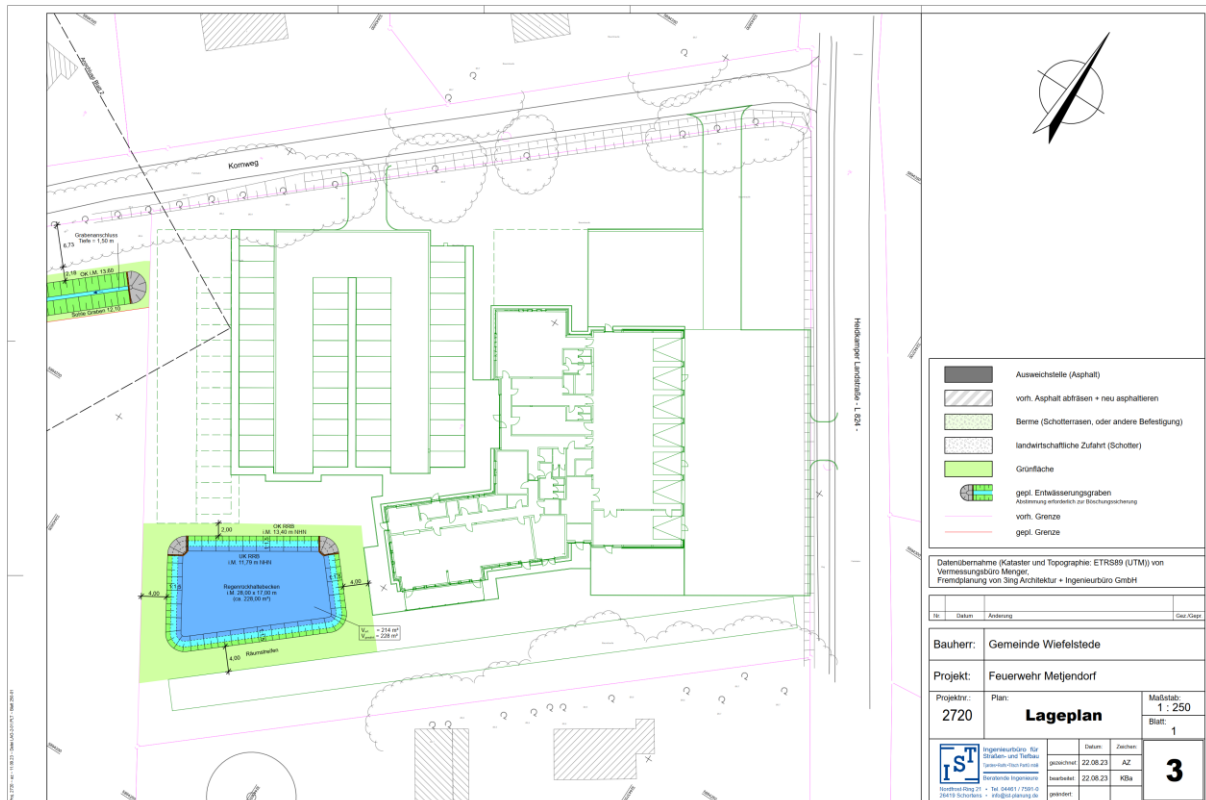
Lageplan zum Oberflächenentwässerungskonzept, IST(08/2023)
